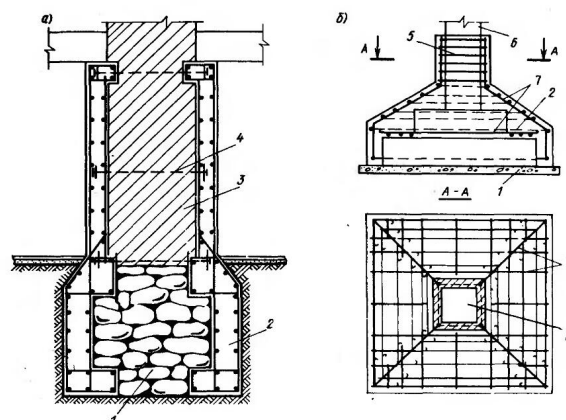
Формирование напряжений в бетонном ядре железобетонных полых конструкций: а – ленточный фундамент колонны; б – столбчатый фундамент колонны
